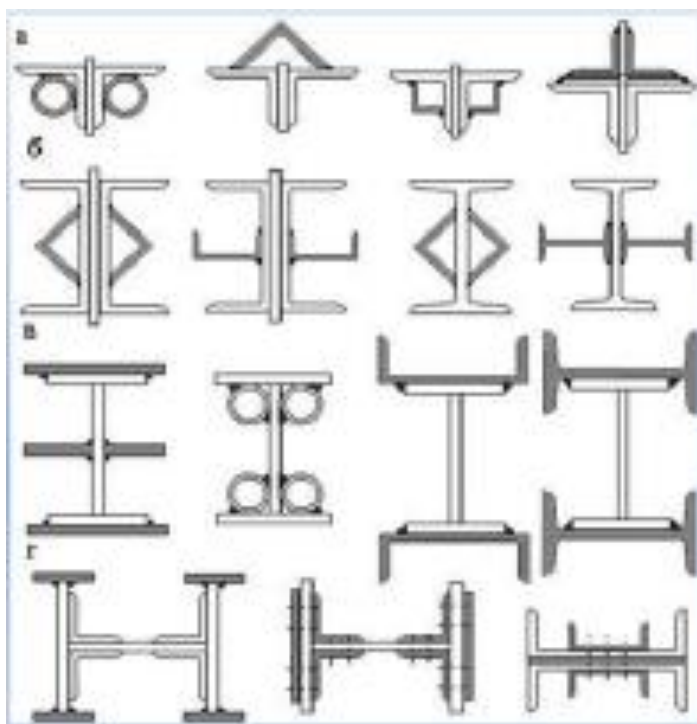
Усиление увеличением поперечного сечения с уменьшением гибкости металлических элементов: а – из спаренных уголков; б – из спаренных швеллеров и двутавров; в – сварных сплошного сечения; г – клепаных
